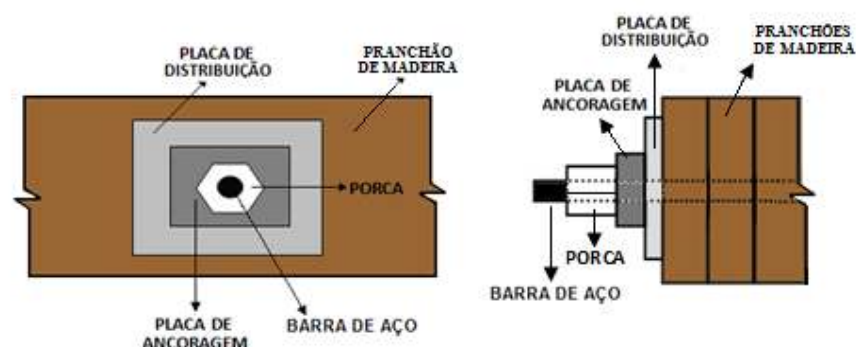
Sistema de protensão para pontes de madeira (vista lateral e corte transversal)
